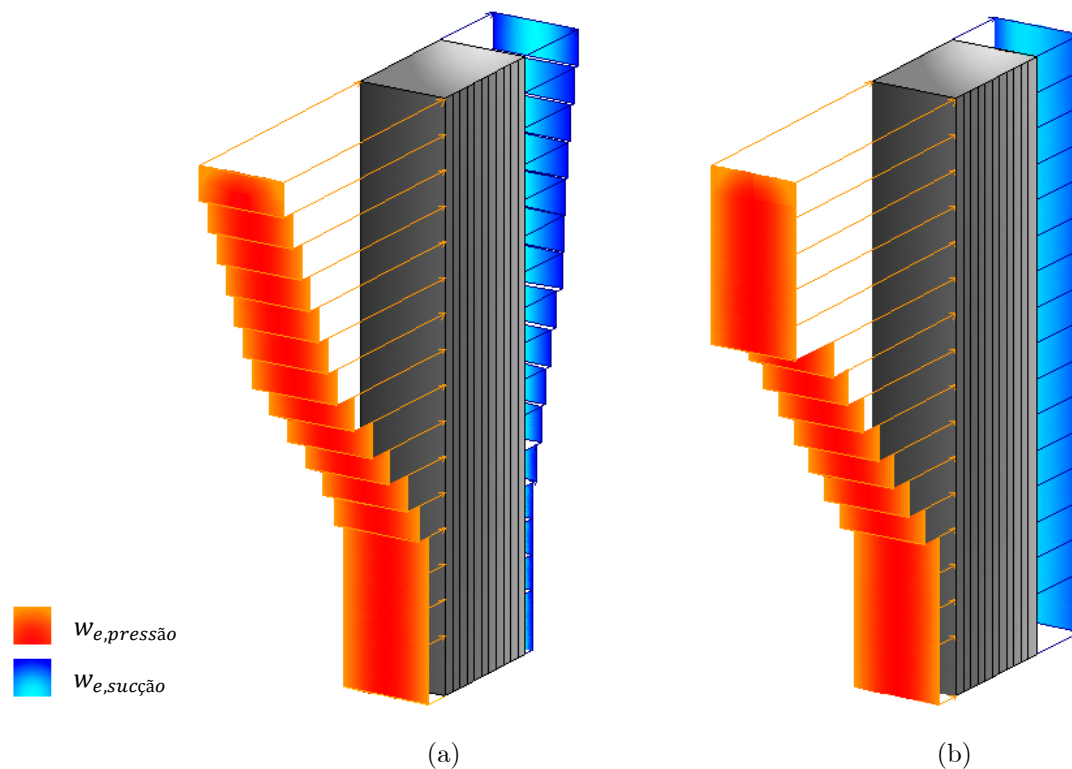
Diagrama de pressões exteriores para as fachadas de barlavento e sotavento:
